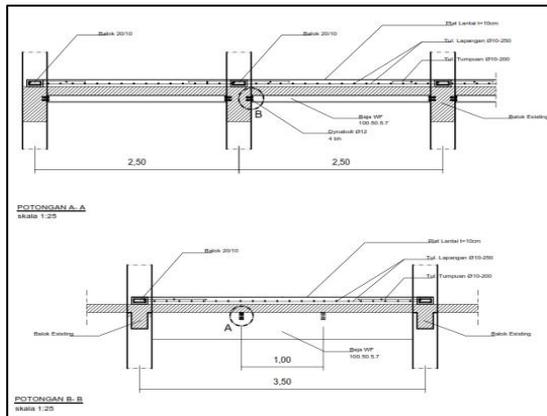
Denah Penambahan Balok 10/20 dan Baja WF
